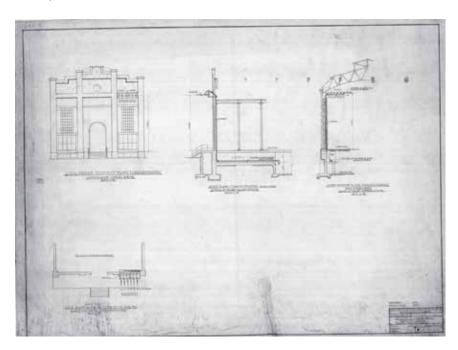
Plano A-2242 "Detalles de Llegada y entrada de cables al edificio. Planta Turbogeneradores", 8 de abril de 1961. AHF.
